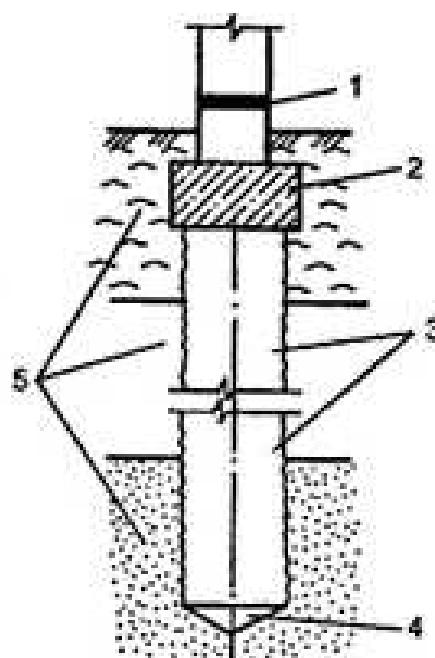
Вид висячей сваи-стойки: 1 – гидроизоляция; 2 – железобетонная балка ростверка; 3 – набивная свая; 4 – наконечник обсадной трубы; 5 – слабые грунты
